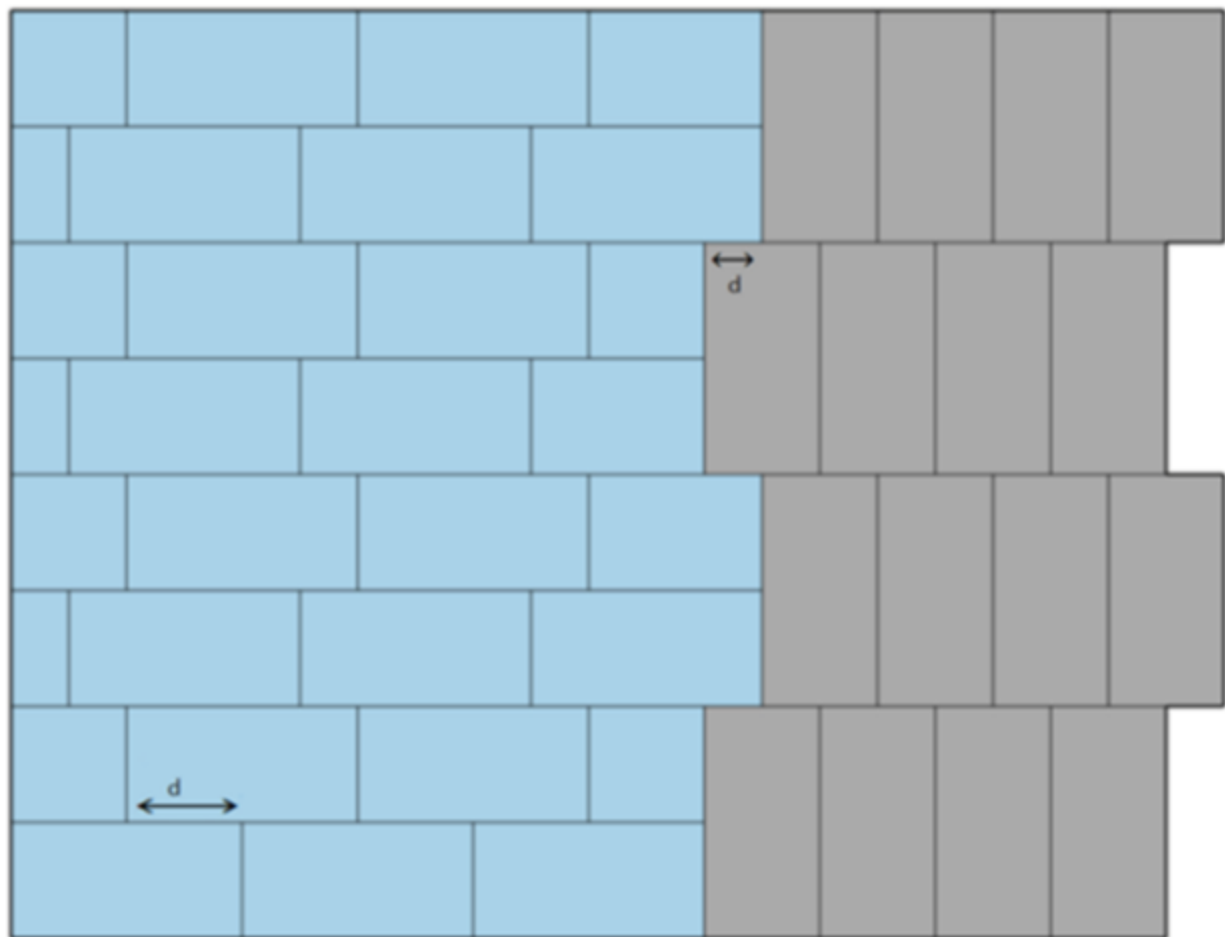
Plans de chevillage - panneaux de dimensions 1200 × 600 mm
